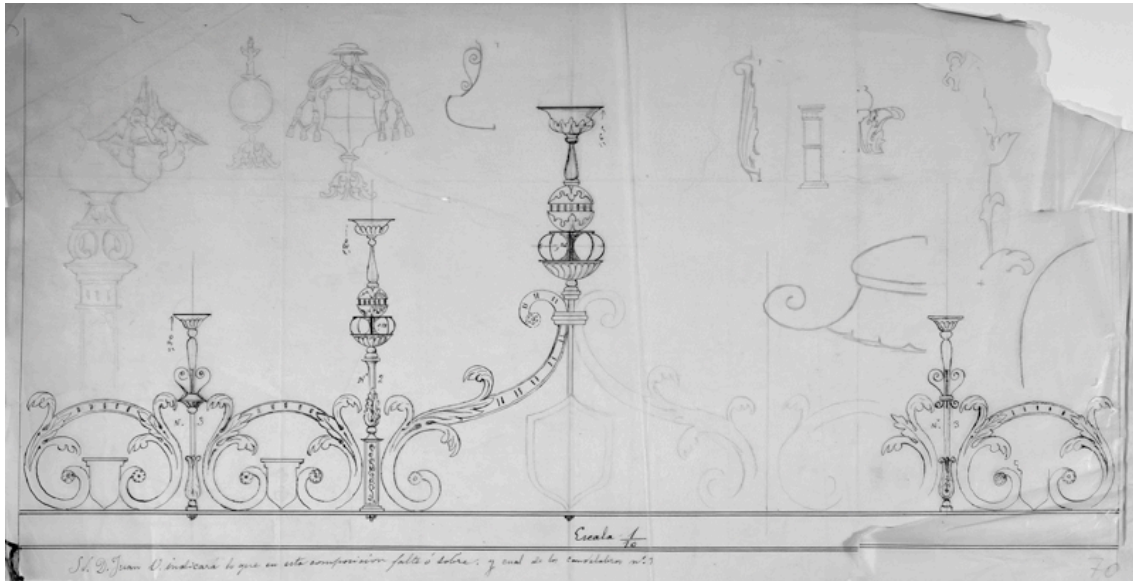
[J. B. Lázaro]: Estudio en alzado de la crestería de la reja interior del primer intercolumnio más cercano al crucero. Plano presentado a Lázaro para que este seleccionase el candelabro decorativo que le pareciera más adecuado; sin embargo, los candelabros finalmente ejecutados no coinciden con los aquí reflejados, aunque presentan cierta similitud (ca. 1895). Fuente: ACL, R.(P) 586r [Fotografía del autor].
